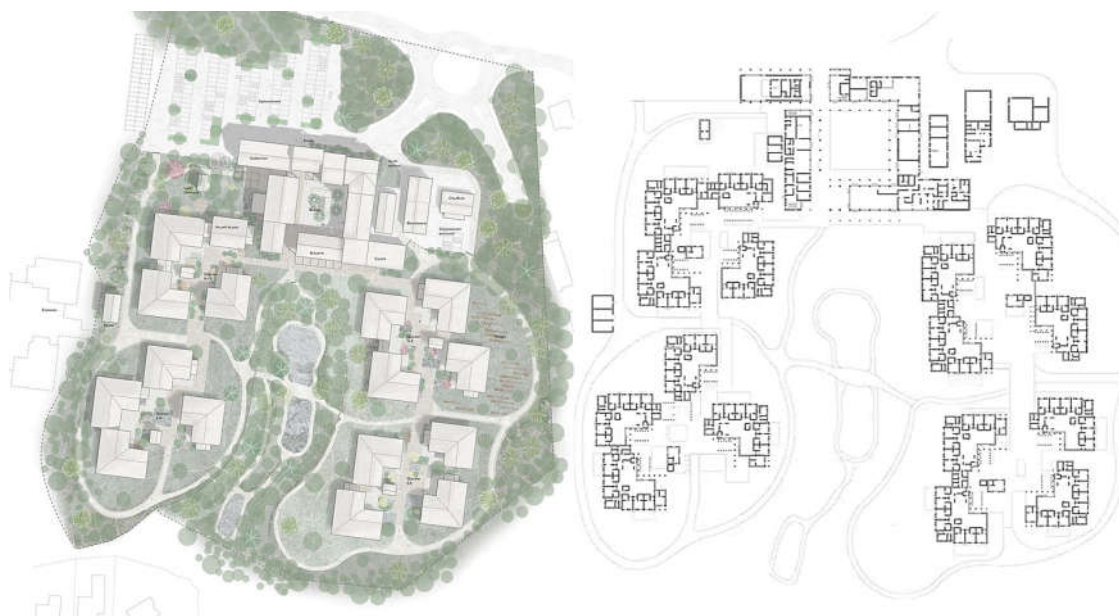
1.16. Генеральний план Alzheimer's Village. Архітектурне бюро: Champagnat & Gregoire Architects, NORD Architects. [46, 47].
